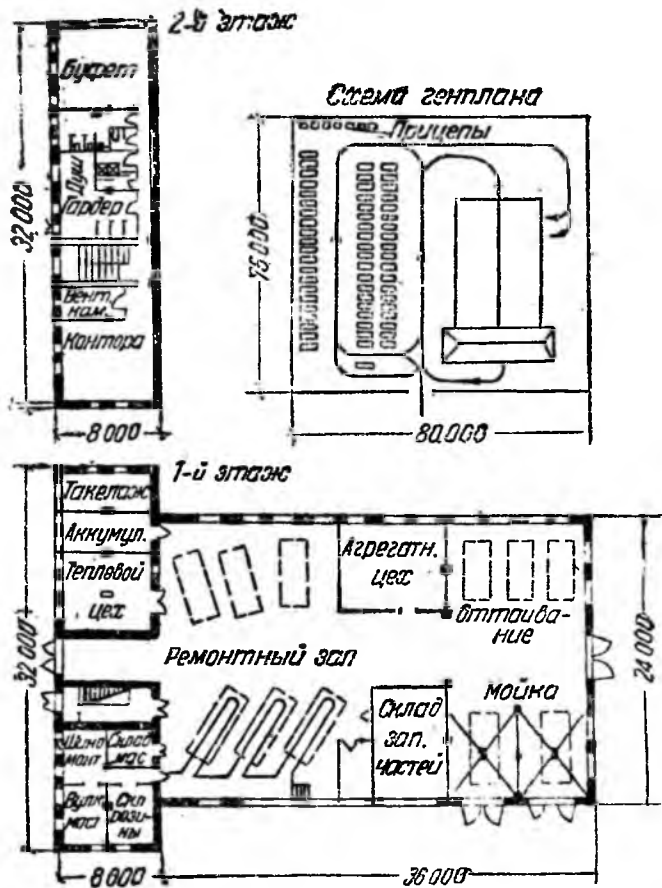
Планы типового гаража на 60 машин с открытой стоянкой
